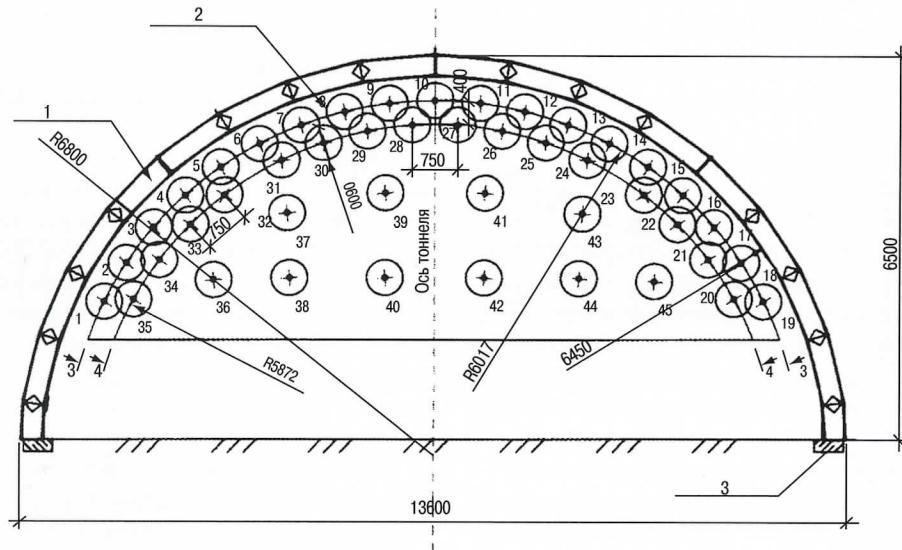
Схема устройства грунто-цементных свай: 1 – арка из двутавра №35; 2 – скважины опережающего крепления по технологии Jet-Grouting; 3 – опорная ж/б плита под пятку арки
